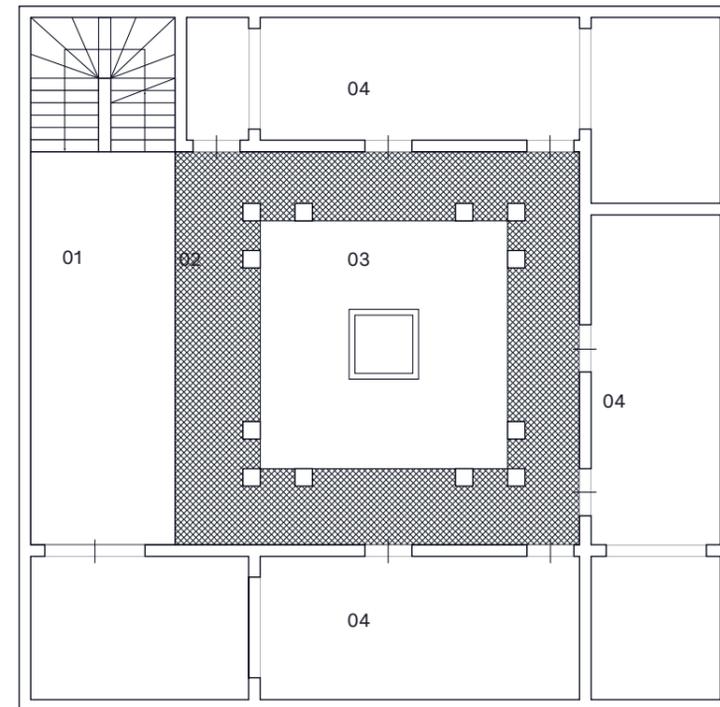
Grundriss eines typischen Stadthauses in Marokko
